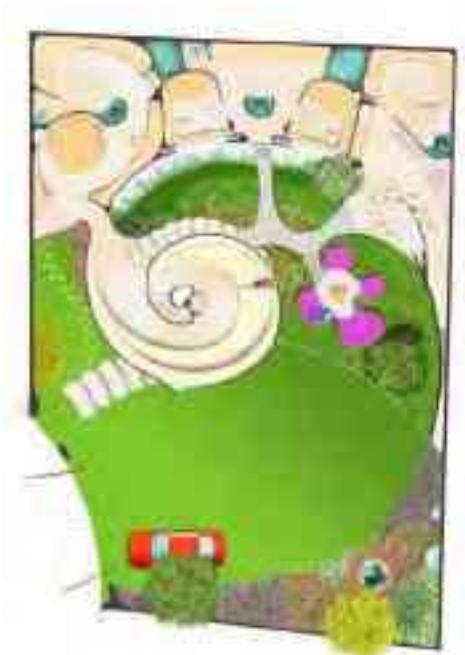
Planta arquitectónica de la casa Nautilus. Obtenido de arquitecturaorganica.com
